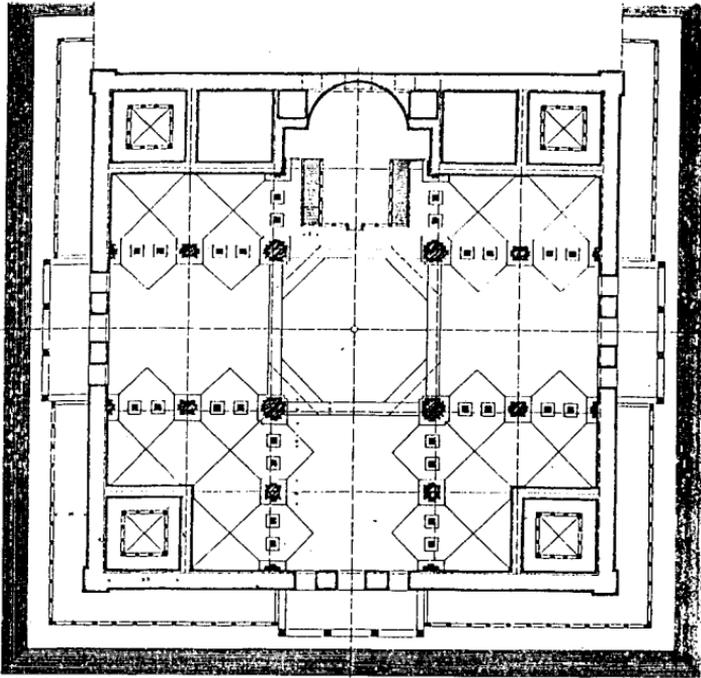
Antonio Averlino, gen. il Filarete, Kathedrale von Sforzinda, Rekonstr. des Grundrisses nach Finoli/Grassi.
